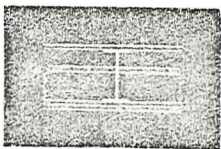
Fransk Etageadskillelse med indlagt Jerndrager.
